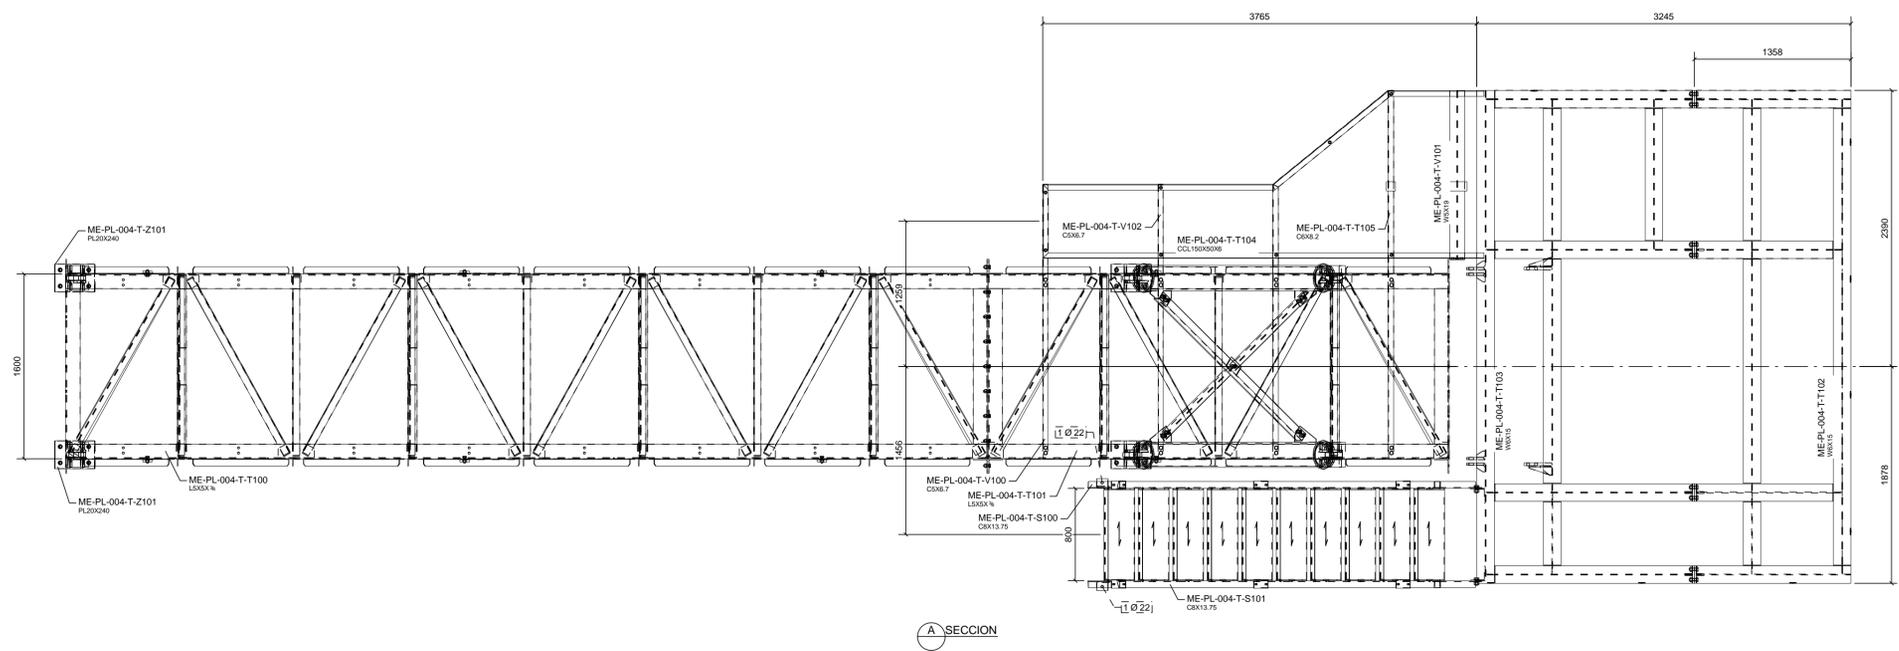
PLANO 1 - ESTRUCTURA METÁLICA DE LA FAJA TRANSPORTADORA
